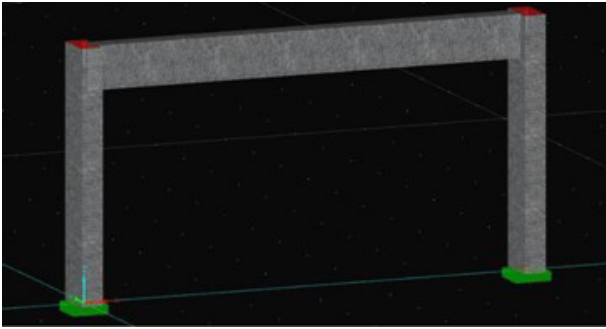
Sistema pilastro-trave. Elaborata dall'autore.
